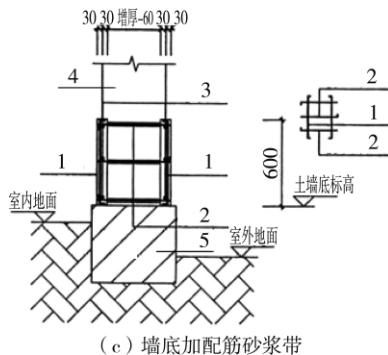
配筋砂浆带加固墙体裂缝
